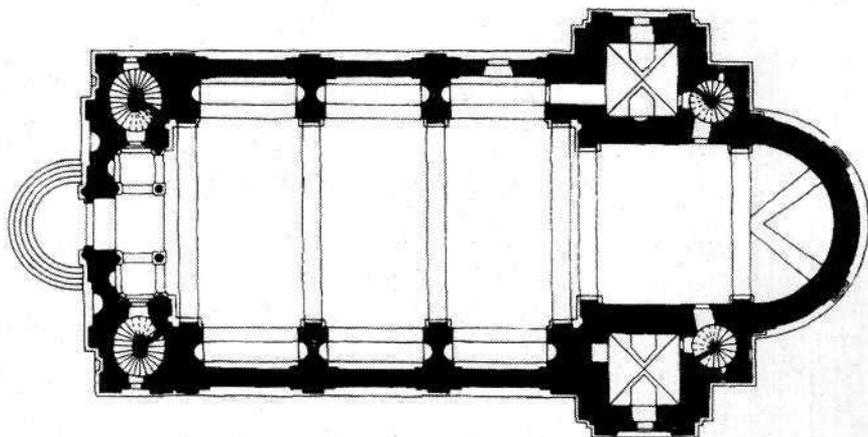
Altbunzlau (Stará Boleslav), Grundriss der Wallfahrtskirche.
